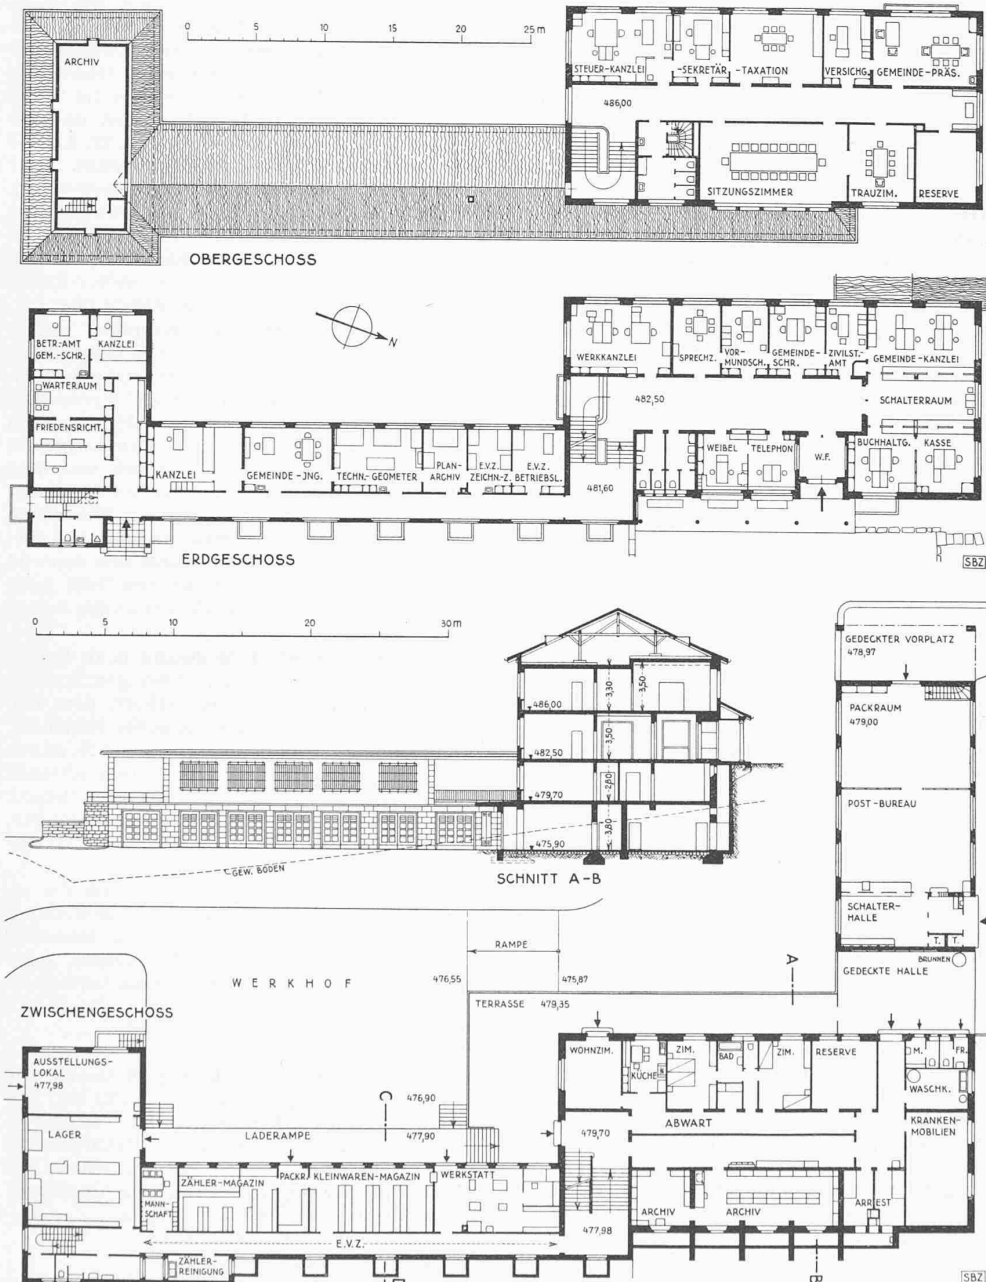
Grundrisse und Schnitt A-B, Masstab 1 : 500
